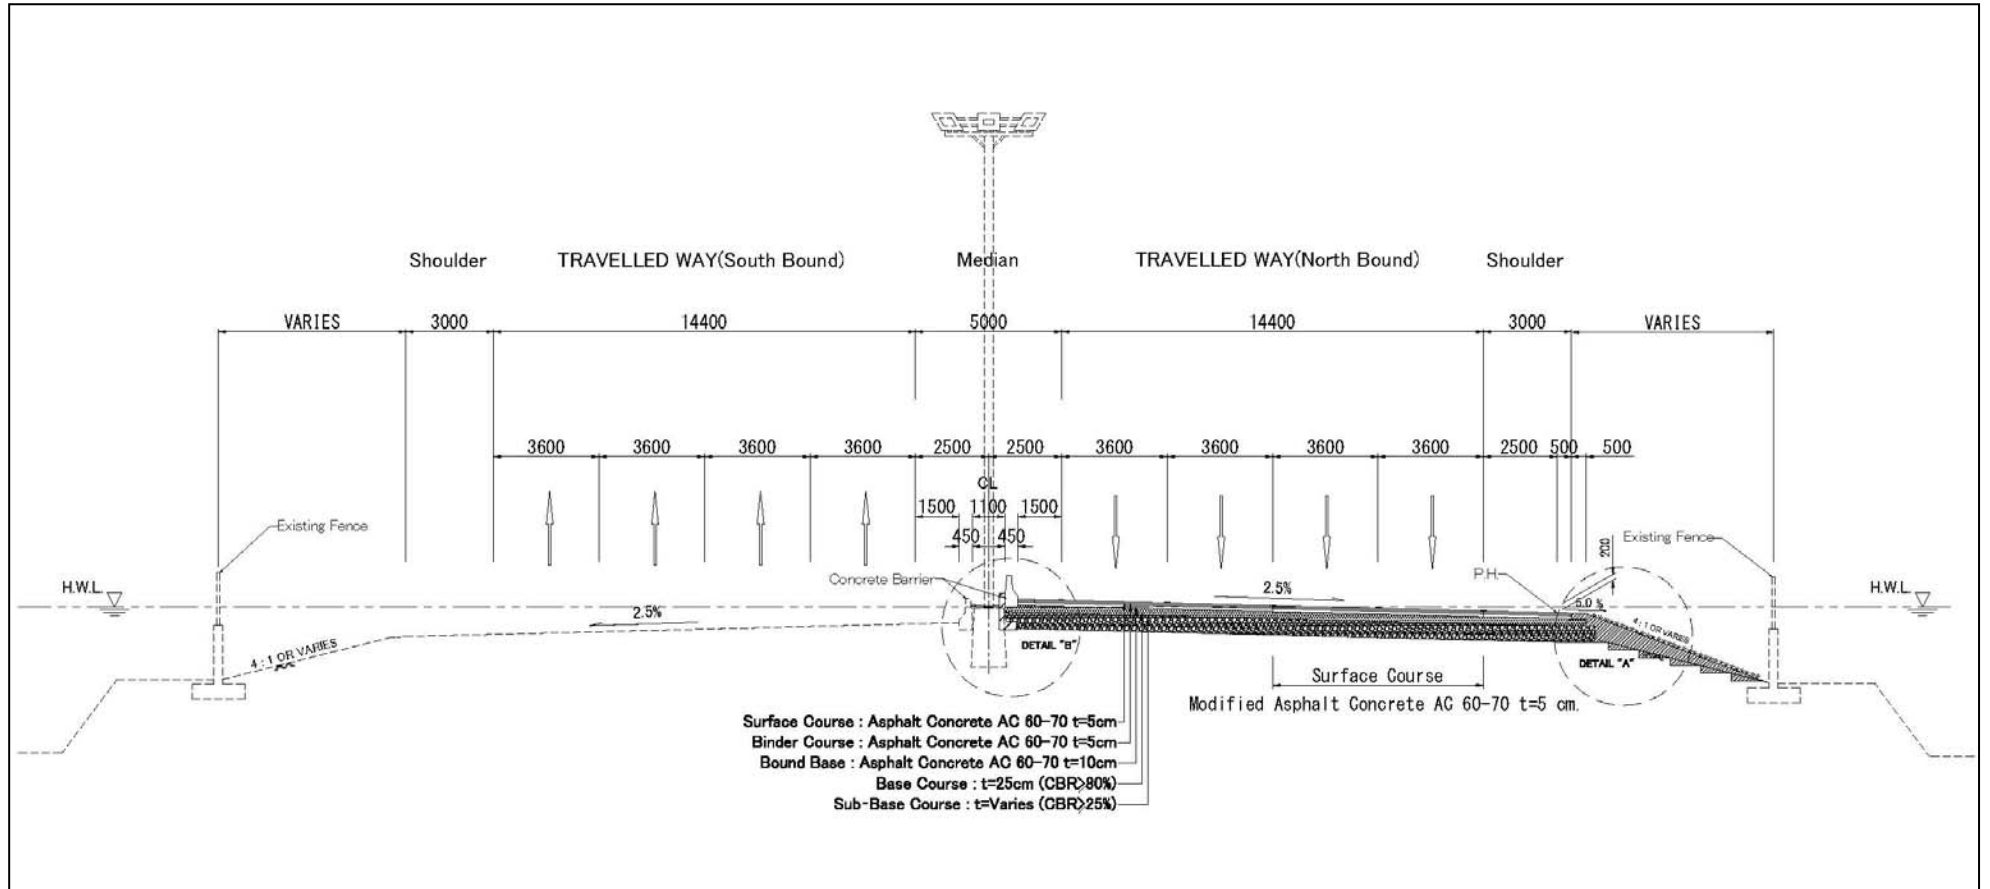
標準横断面図 (一般車道区間の標準断面図)
